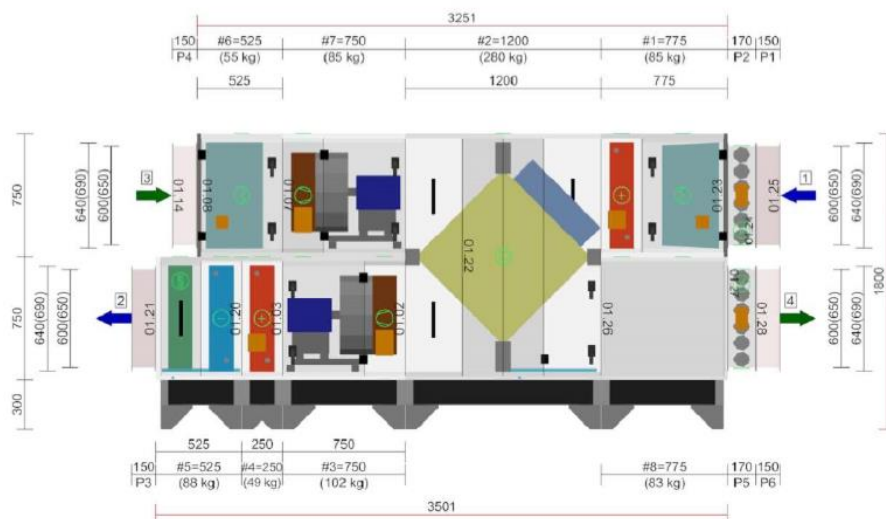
Vzduchotechnické zařízení č. 1 – základní informace
